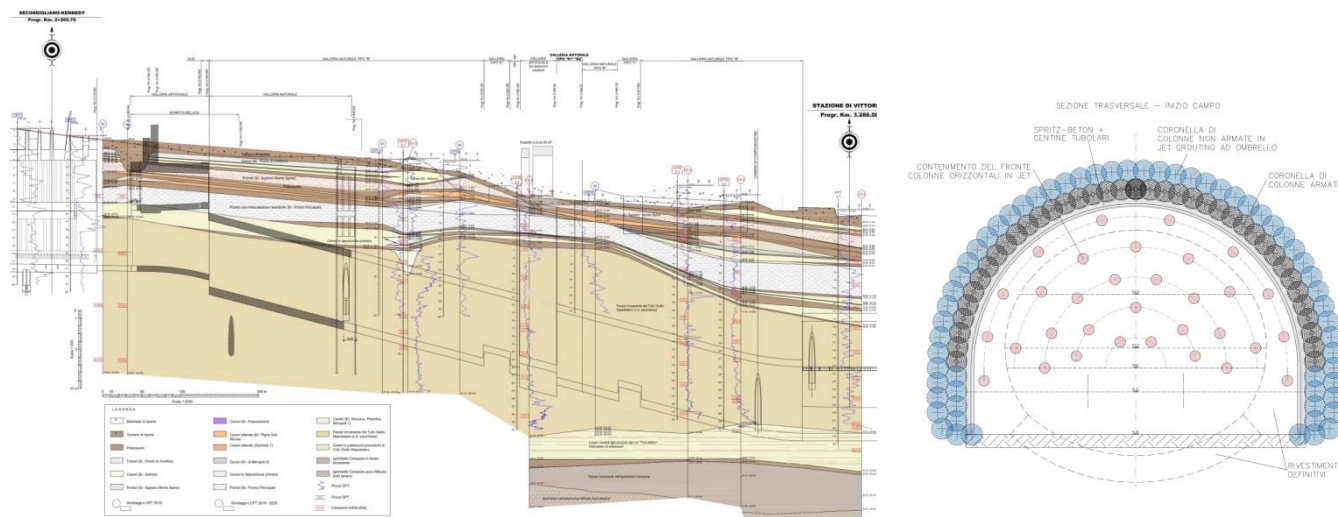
Sezione geologica con inquadramento planimetrico della galleria da realizzare (a sinistra). Sezione trasversale tipo, con dettaglio degli interventi di preconsolidamento (a destra).
